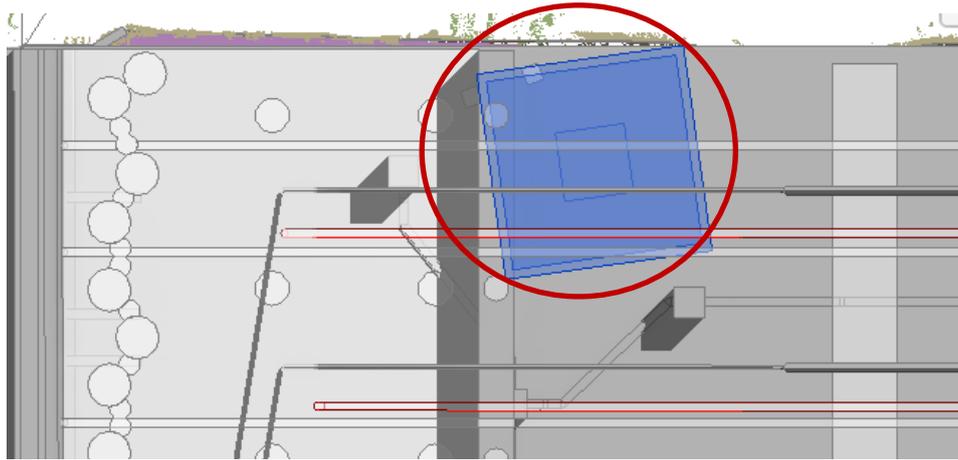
Bunge Nord – Vista dal basso Torre Faro
